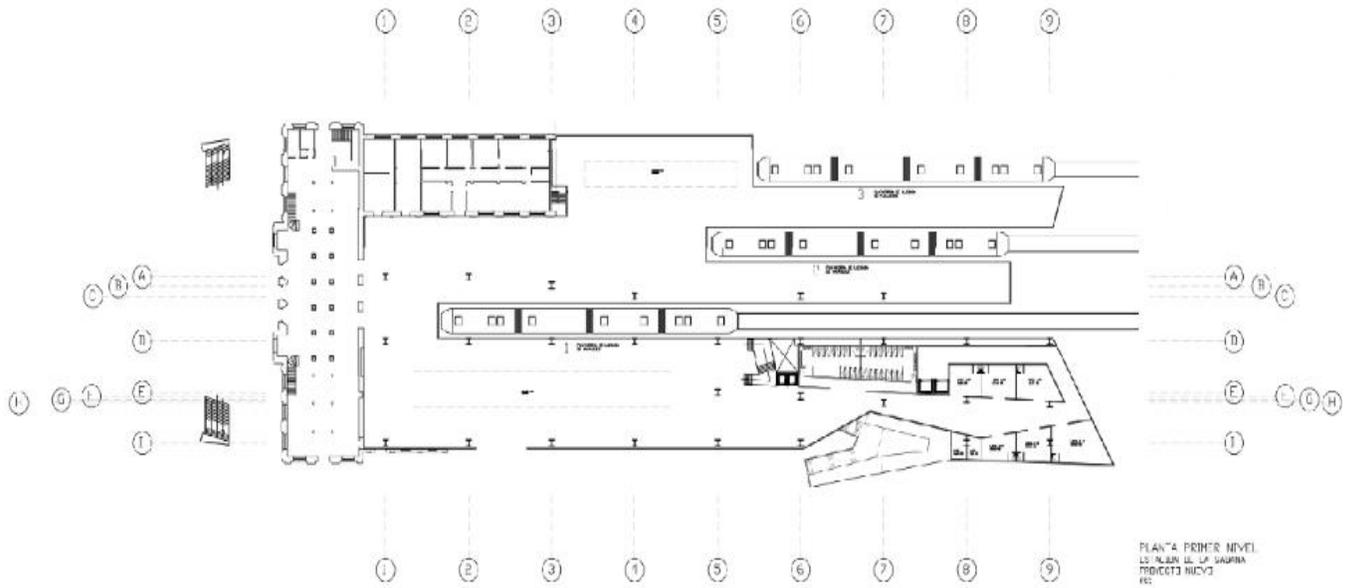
Planta Primer nivel proyecto nuevo. Estación de la Sabana.
